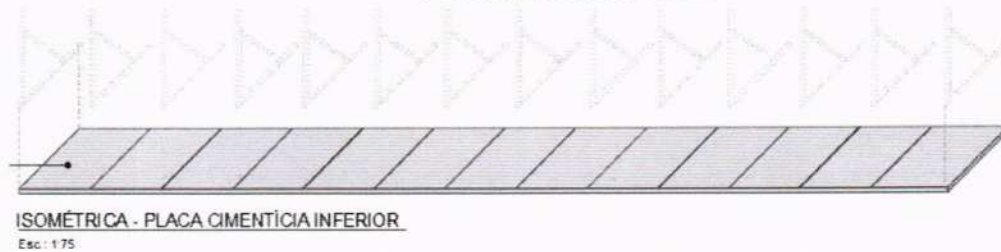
Detalhamento cobertura da fachada da Unidade de Saúde Paulo Kondo em Placas cimentícias.
